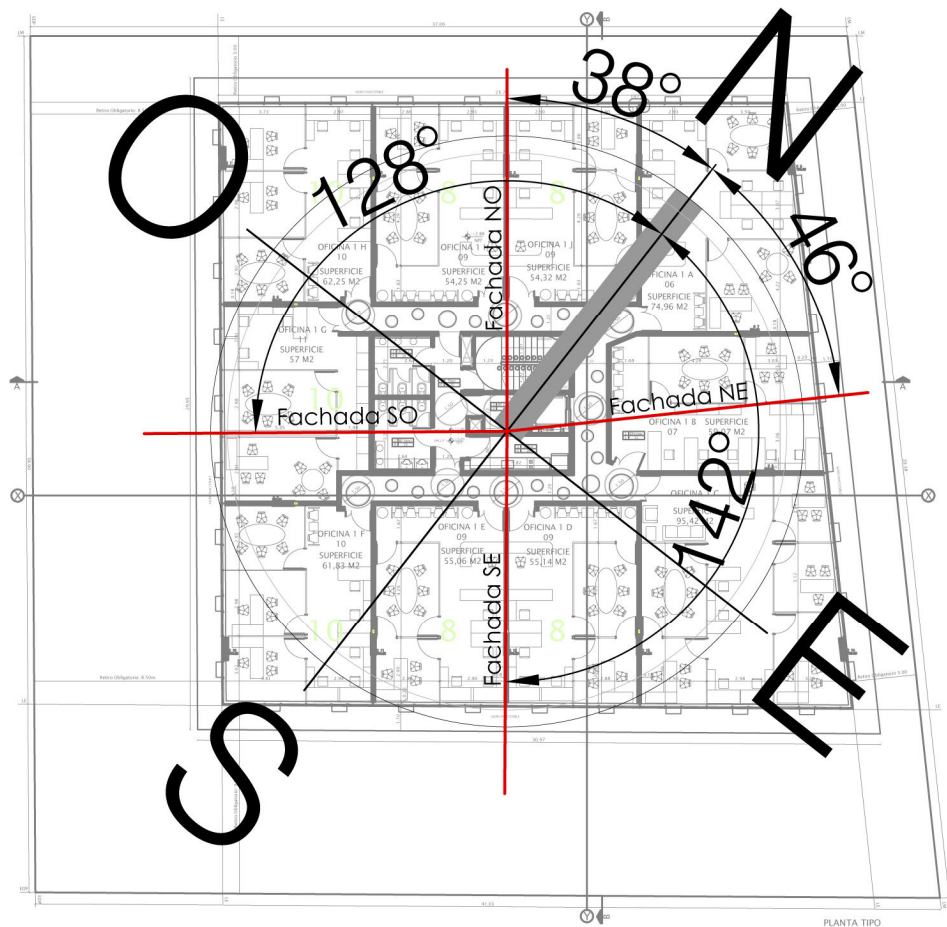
Implantación, Norte y azimut (ángulo en planta respecto al Norte) de las fachadas.
